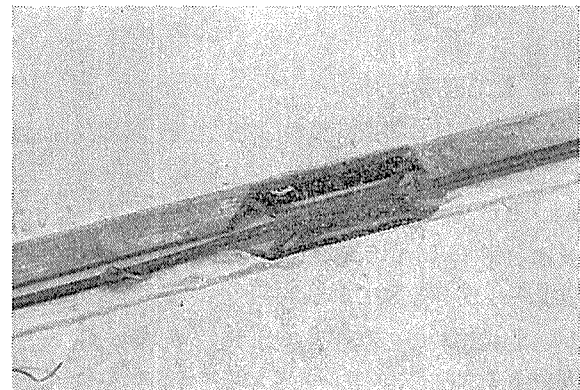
ダブルTスラブ各継手の溶接接続
